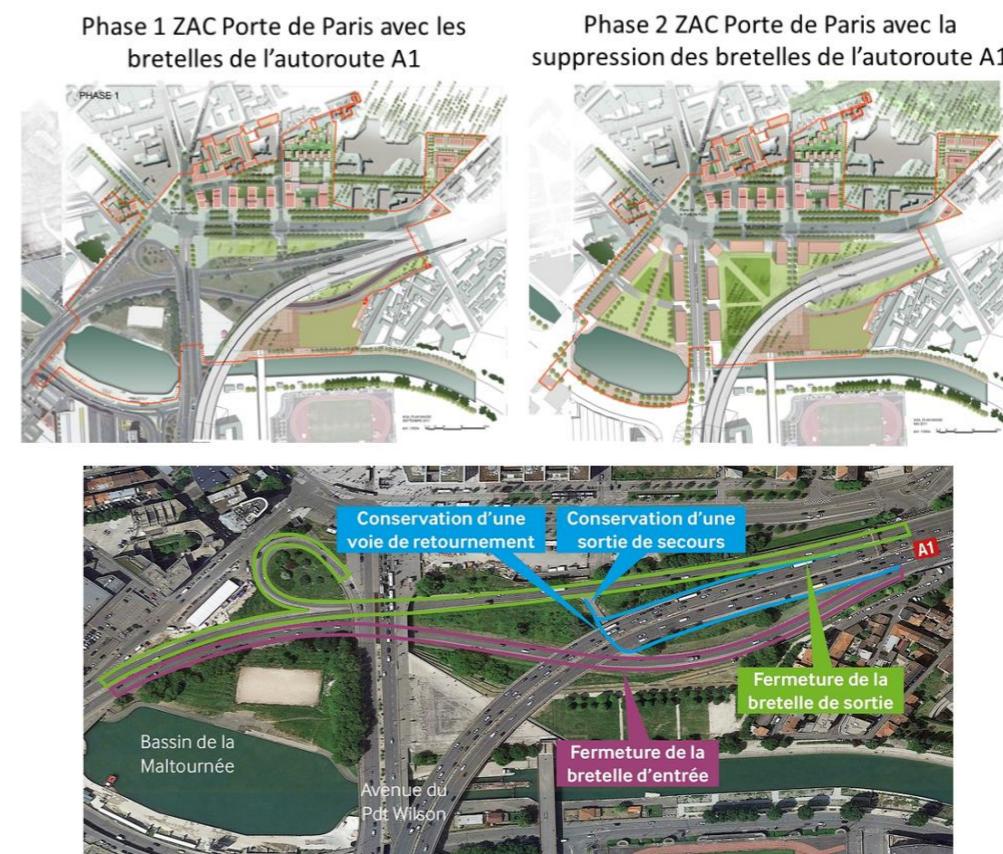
Projet de suppression des bretelles de l'autoroute A1
